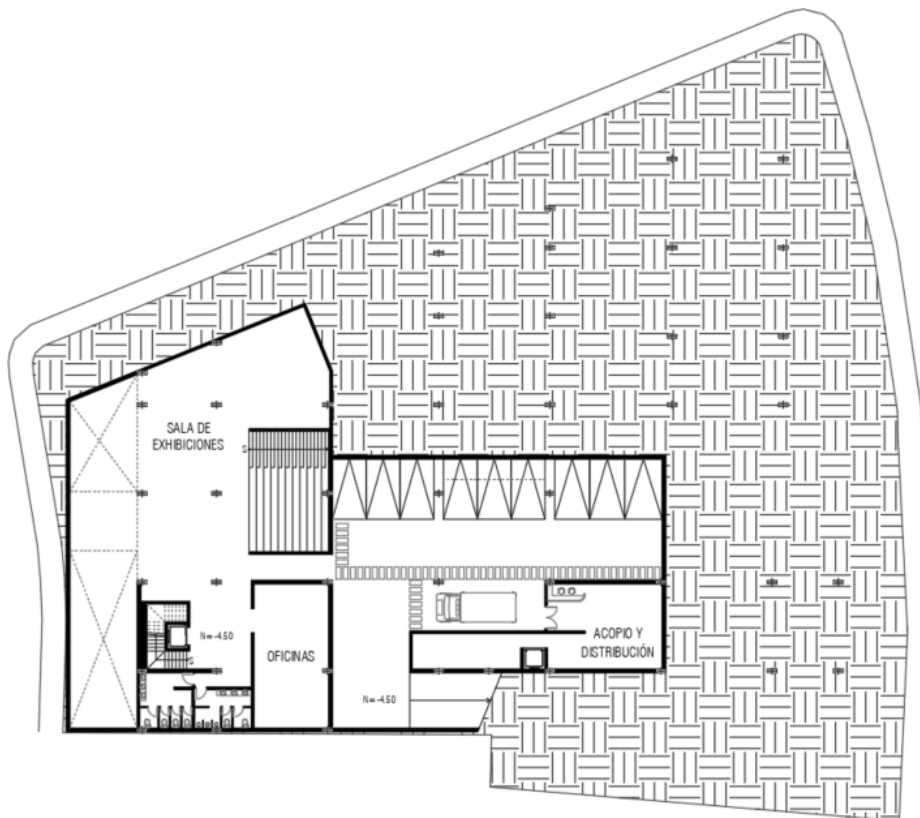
Planta subsuelo - Anteproyecto 02. Elaboración propia.
